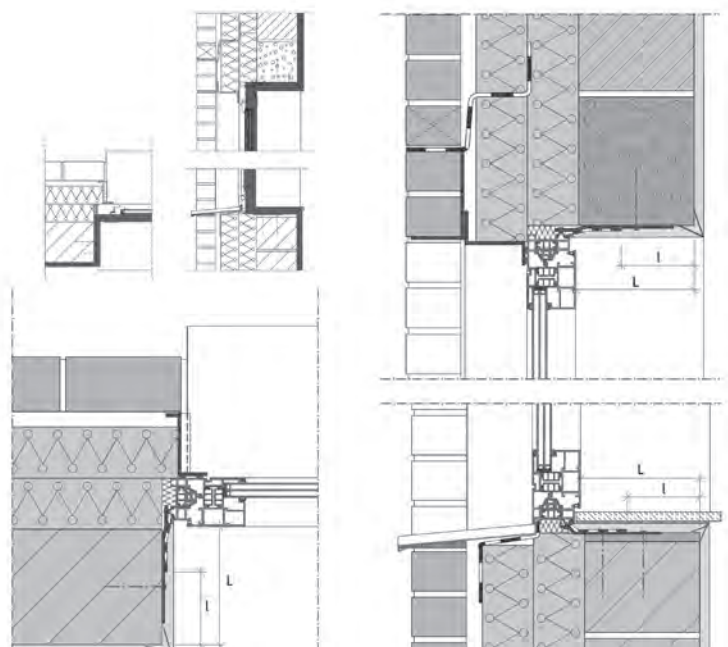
Application d'une membrane d'étanchéité à l'air au droit du raccord entre la menuiserie et le gros oeuvre. (source : CSTC ; NIT 188).
